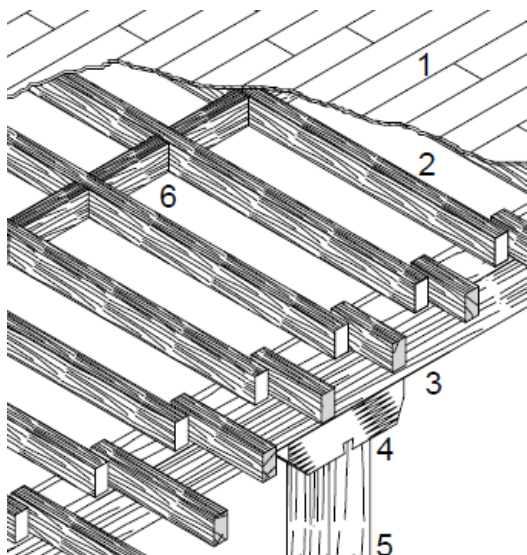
Detalle del entramado de la planta segunda de la fábrica de harina.
